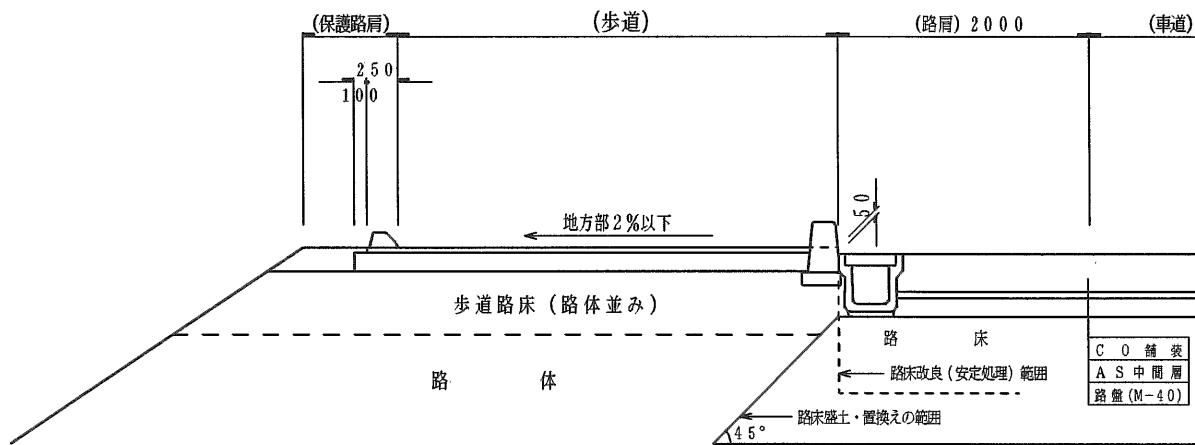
47 路肩端に構造物がある場合（コンクリート舗装） (単位 : mm)
